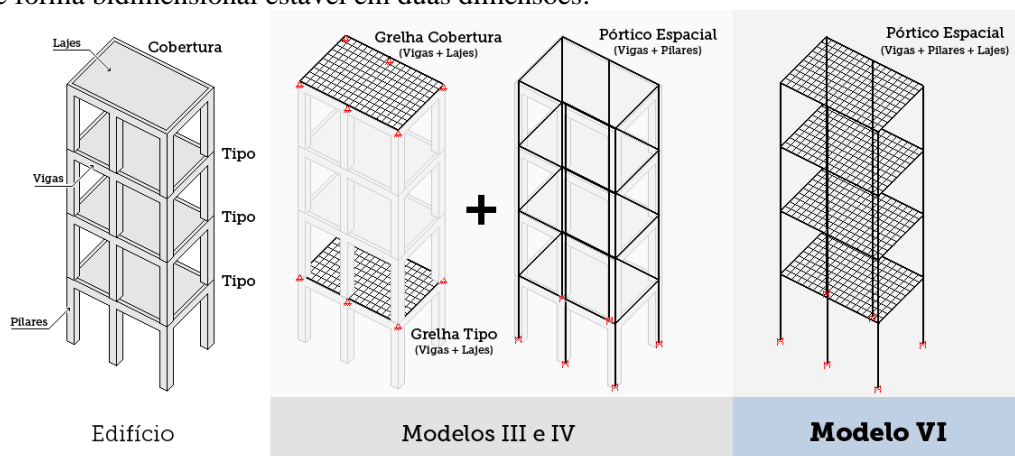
Representação de modelo estrutural de edifício em pórtico tridimensional formado por barras (vigas e pilares) e grelhas (lajes). (CAD/TQS 16 Informática LTDA (2018)).
